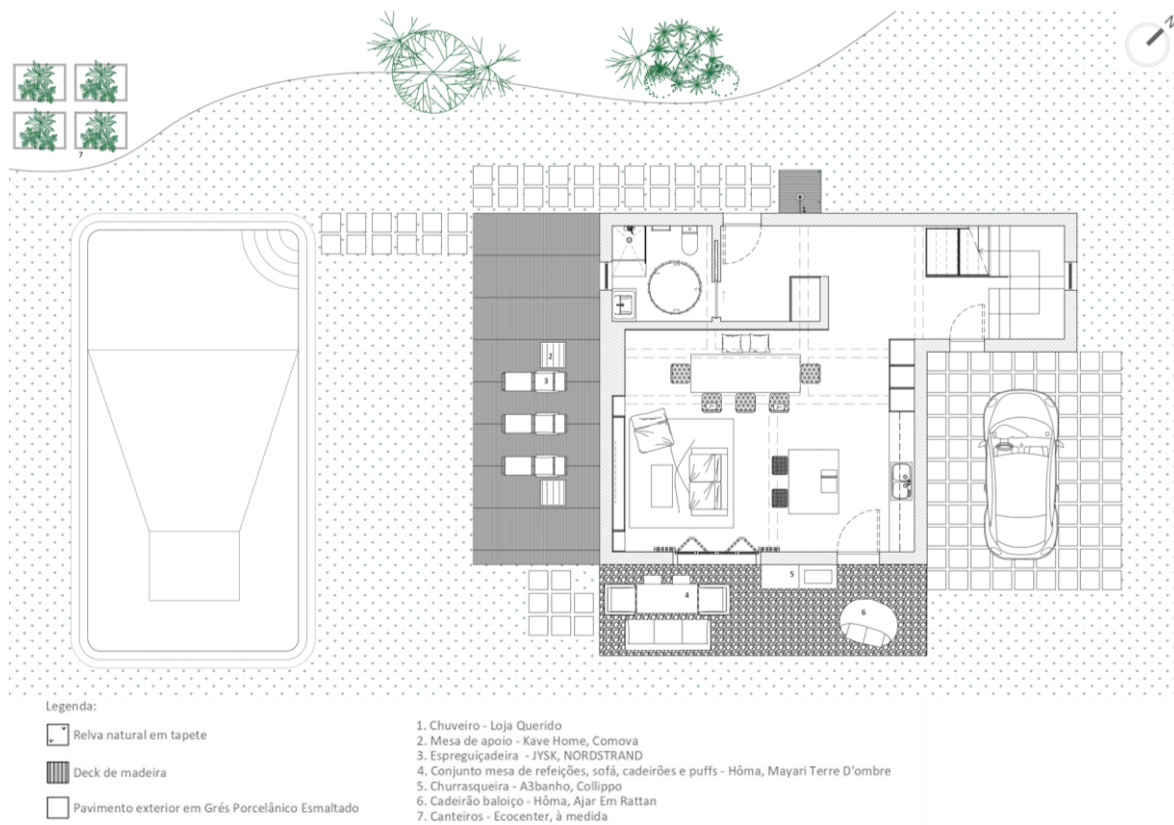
Planta de Proposta de Arranjos Exteriores. Fonte: Autor
